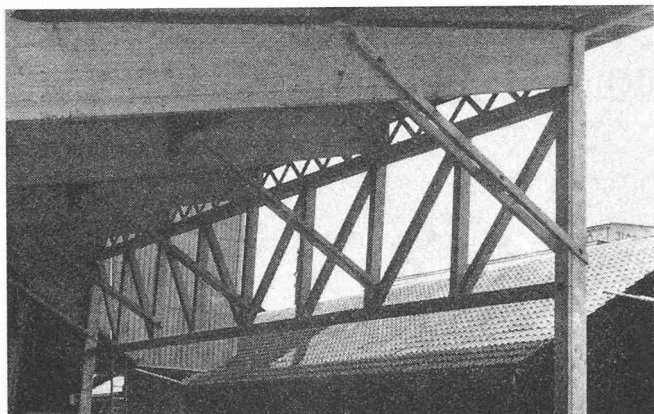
Fachwerk aus verleimten Einzelteilen. In den Knotenpunkten sind Stahllamellen eingeleimt, die über einen Stahlbolzen verbunden sind. Diese Lamellen wurden vorher mittels Araldit mit Fichtenholz furniert. Baujahr 1948. Hersteller: Gribi & Co. AG, Burgdorf
